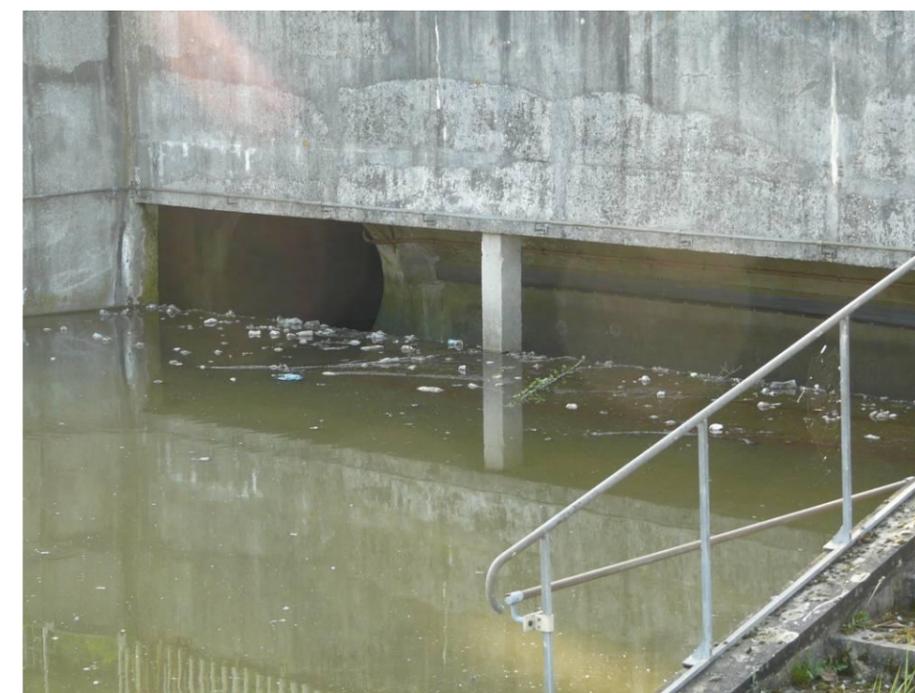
Parc du Sausset - Liaison aval entre le ruisseau du Sausset et l'Étang de Savigny - Ouvrage DEA (CG93)
